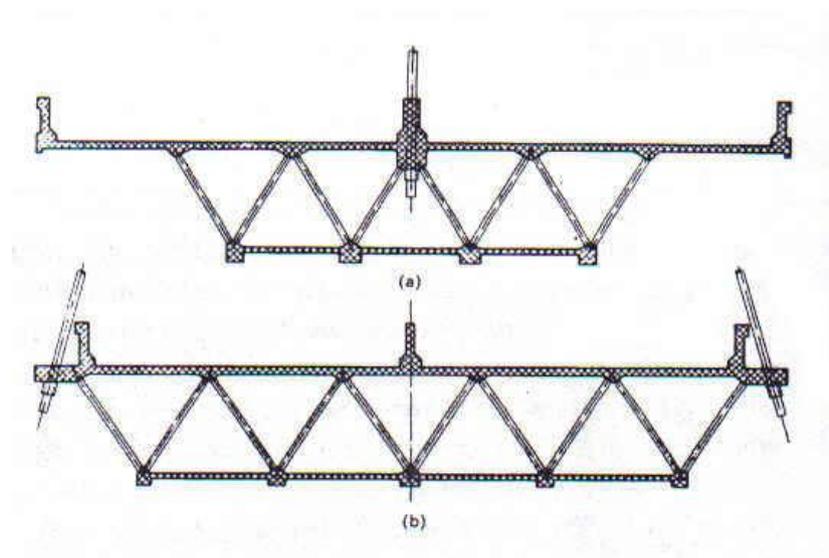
Diseño de tableros para suspensión central y lateral
